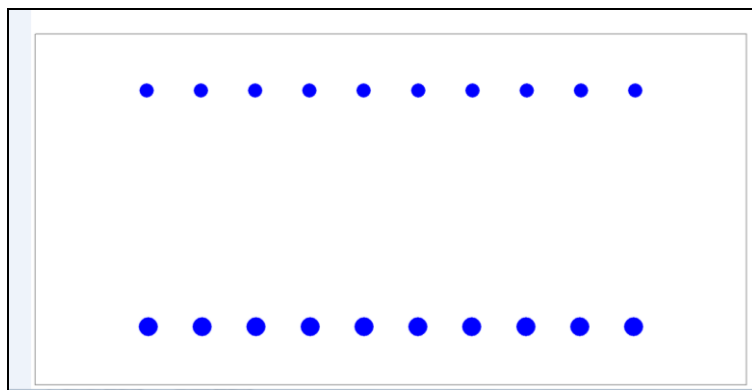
Spalla B – Sezione di calcolo
